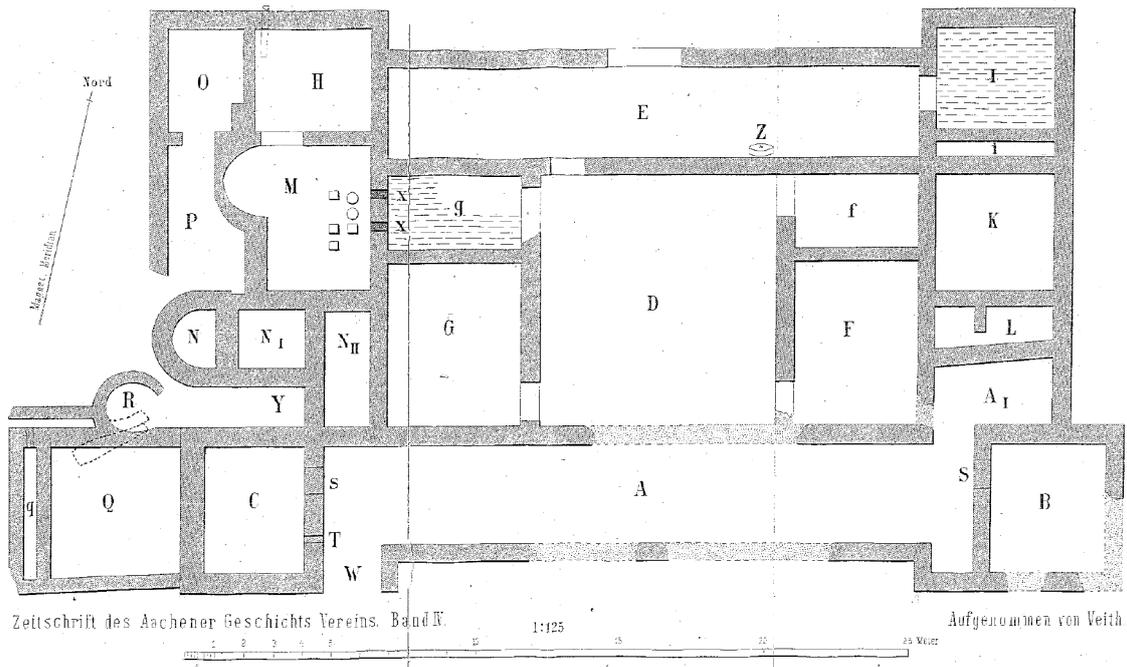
Grundriss des Hauptgebäudes nach F. Berndt.
